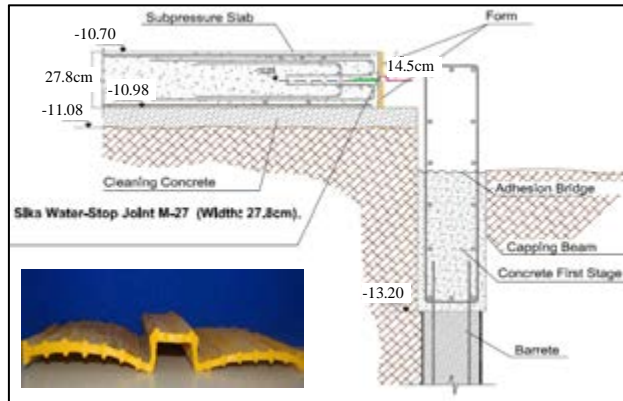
Detalle constructivo de la junta entre fundación de barretas y losa de subpresión.
